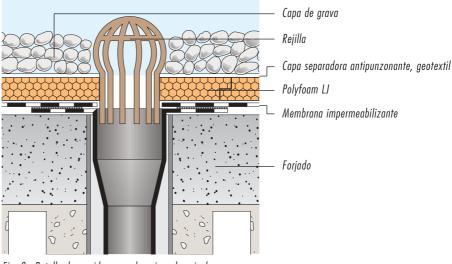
Detalle de sumidero con drenaje a dos niveles: sobre el aislamiento y sobre la membrana impermeabilizante
